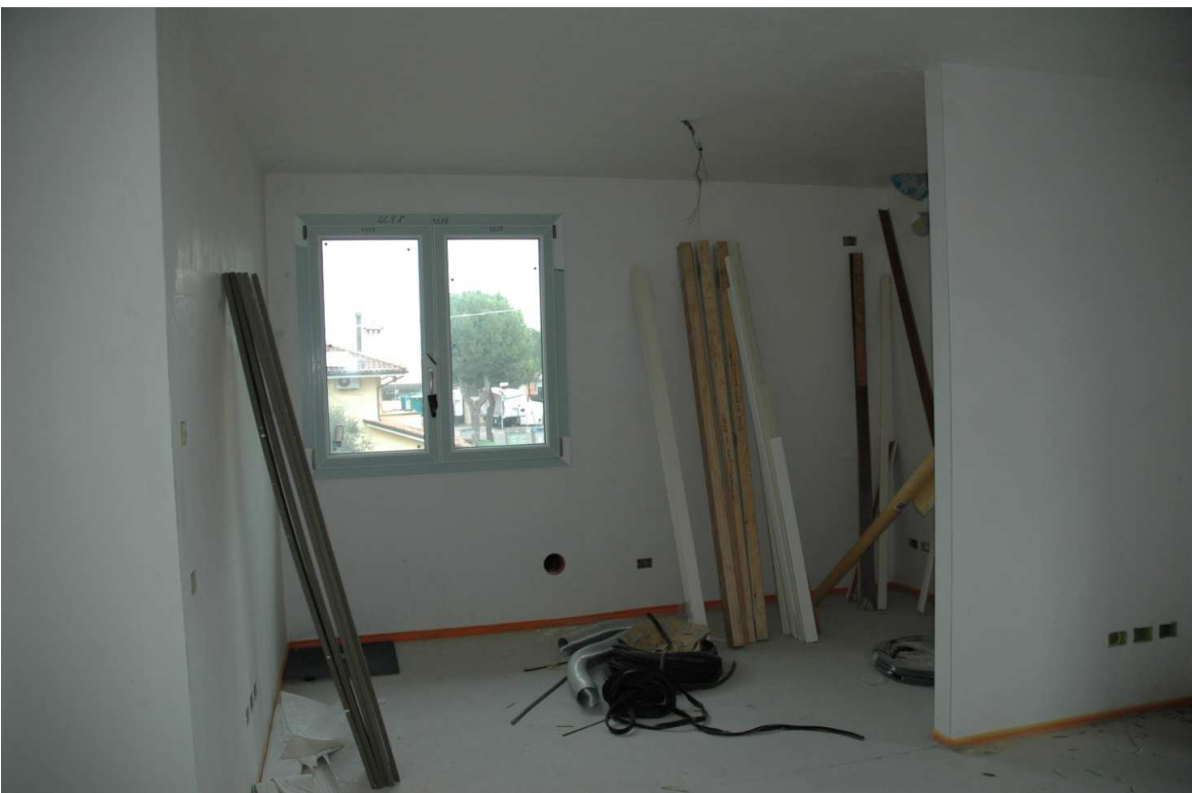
L'appartamento è al piano primo con loggia sul fronte.
